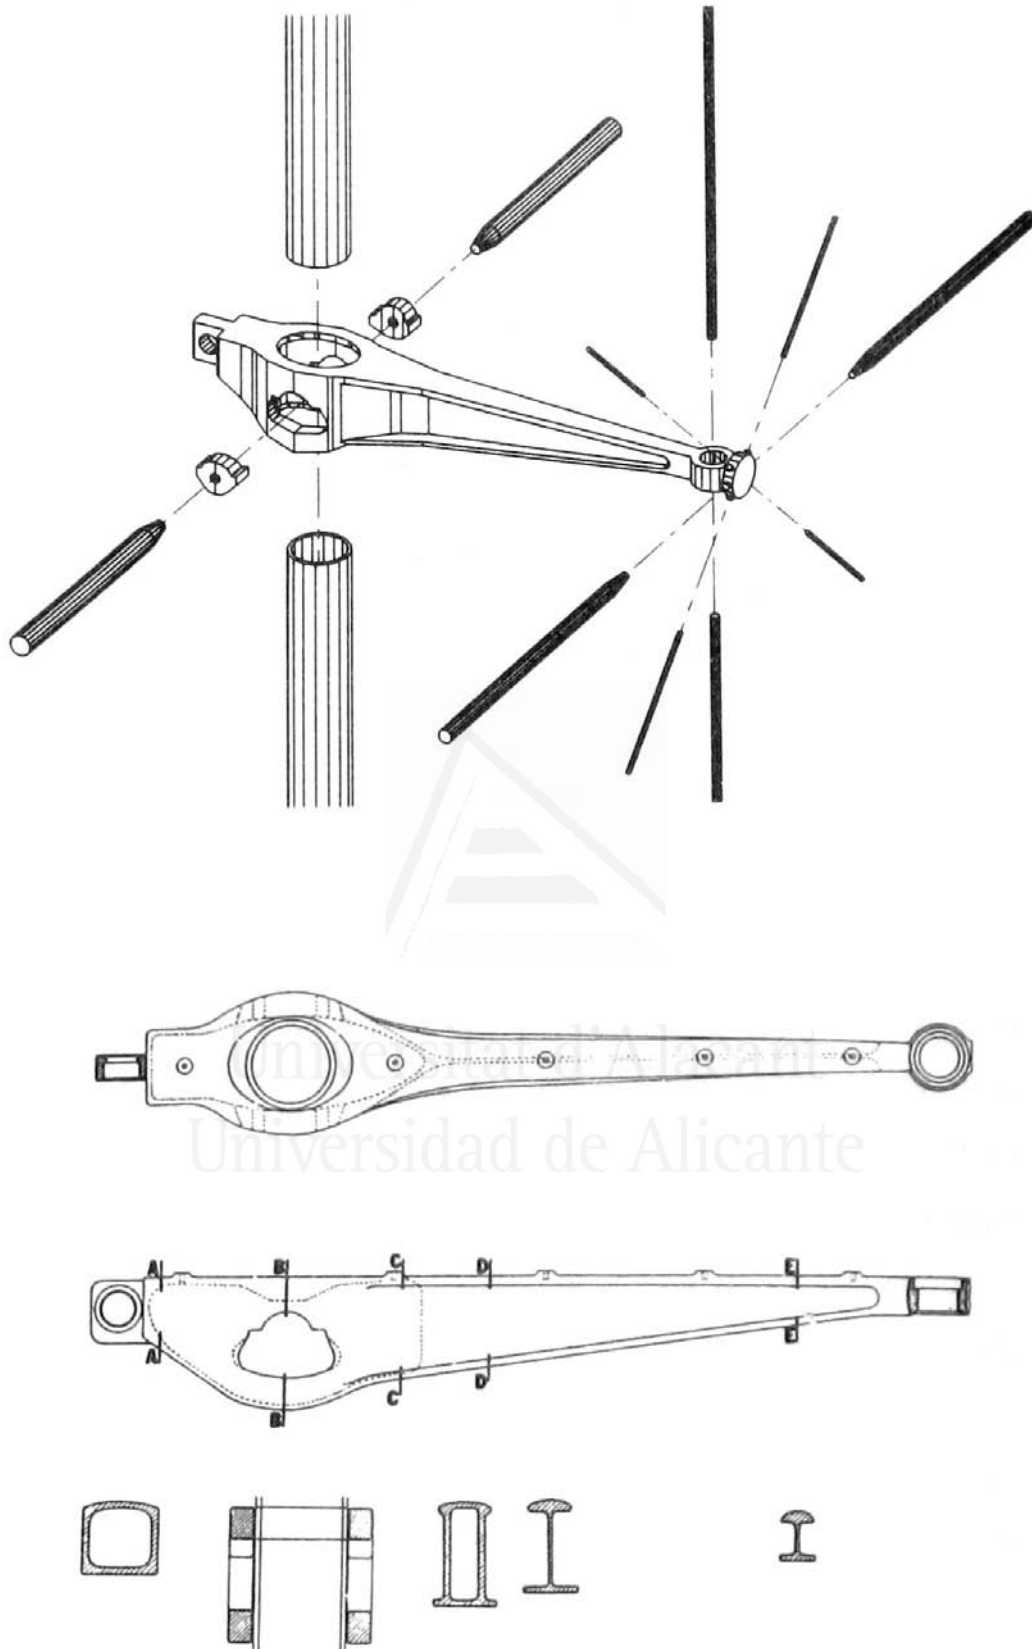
La viga Gerber. Detalle de ensamble con el pilar y con los tirantes. Planta, vista lateral y 5 secciones transversales. Ilustraciones extraídas de "*Mémoires d'un ingénieur*" (Rice, 1998A, pp.28 y 140).
